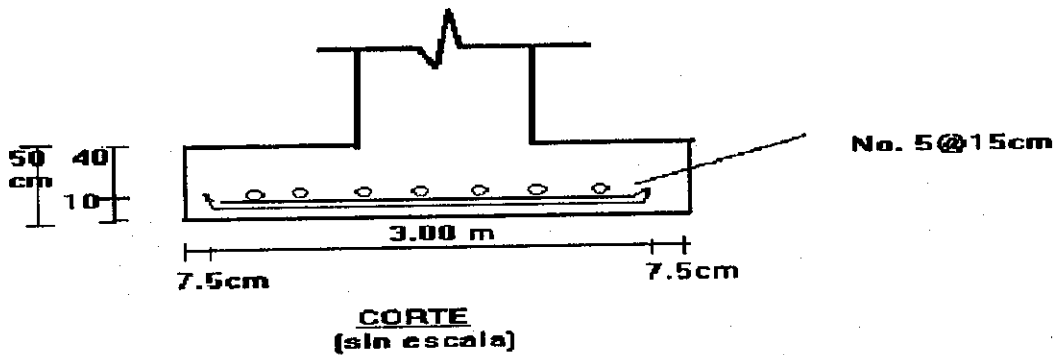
DETALLE DE ZAPATA PARA COLUMNA 14
